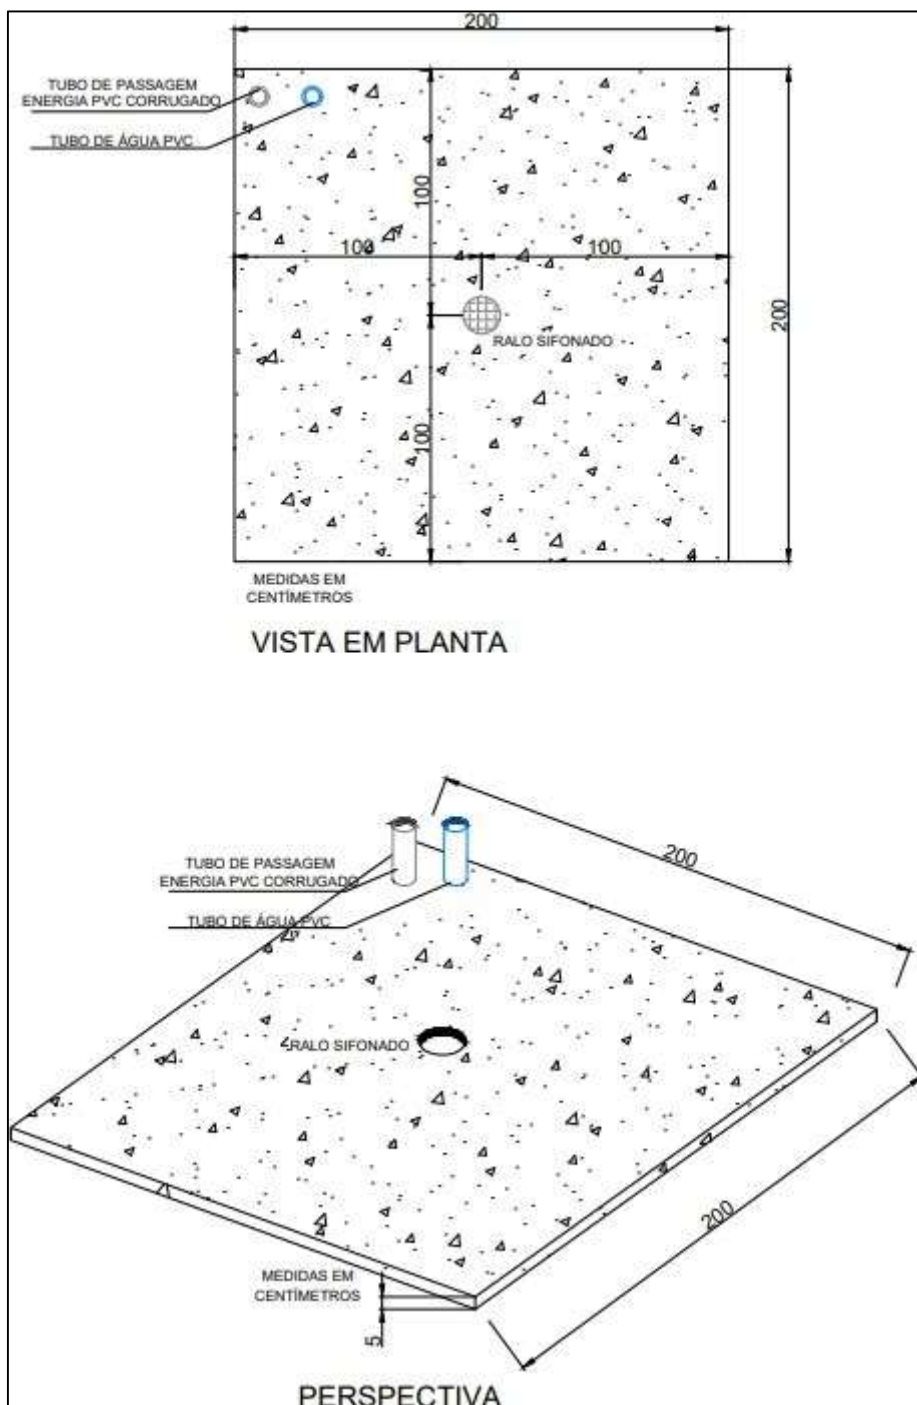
Croqui da base dos totens - Elaboração Samae 2025
